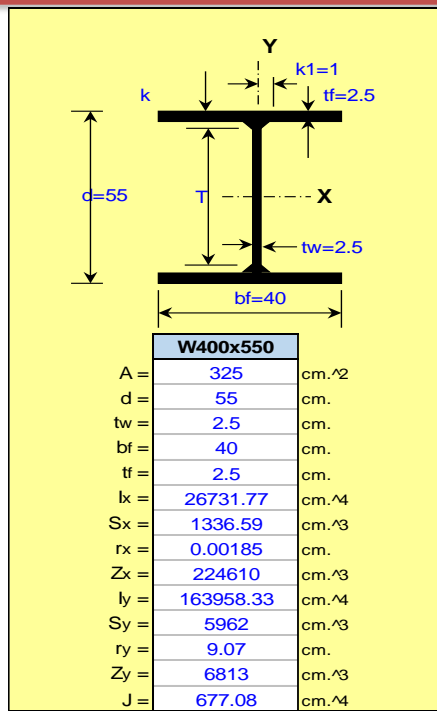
Propiedades del perfil de la Columna "C1" - Sistema estructural mixto.
